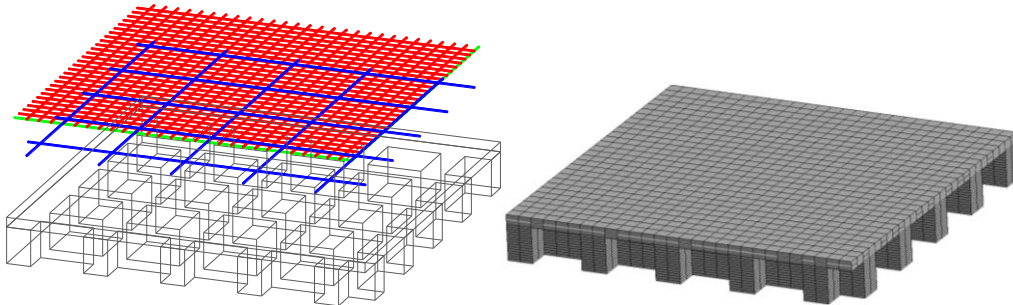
Armado y mallado de la losa encasetonada de 9x9 nervaduras
